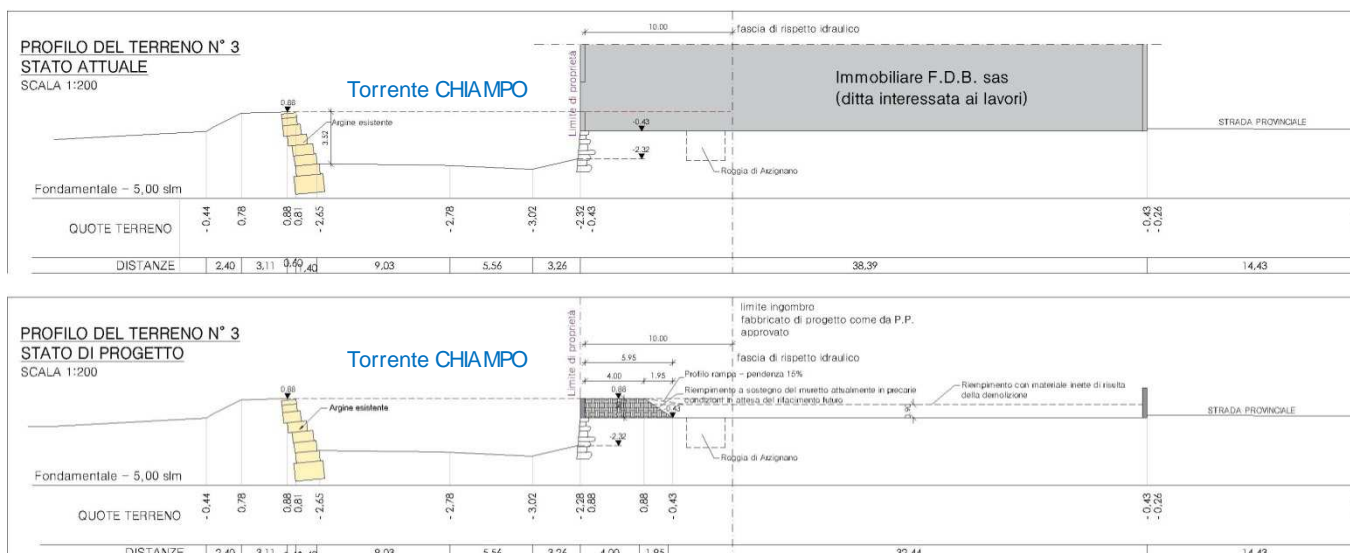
Estratto TAV 3a Profili di progetto di “Riempimento a sostegno del muro attualmente in precarie condizioni in attesa di un rifacimento futuro (Arch. Forti, 28.04.2016)”
